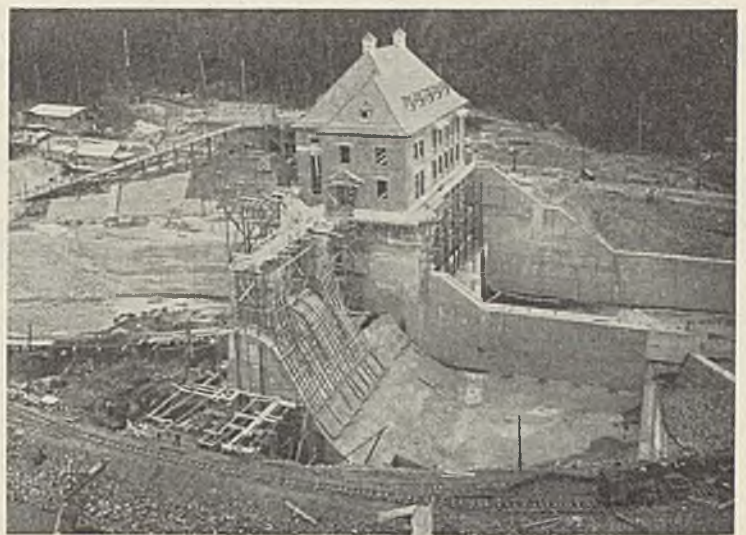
Regensperre. Betoneinbringung im Bauabschnitt II mit Brücke.
